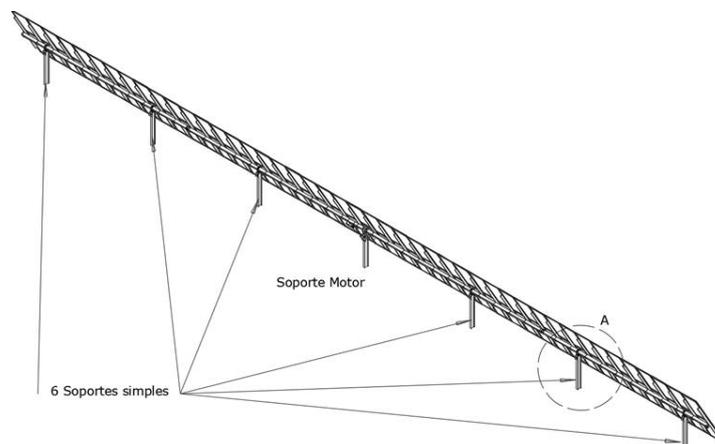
Perfiles de cimentación de estructura seguidor.
